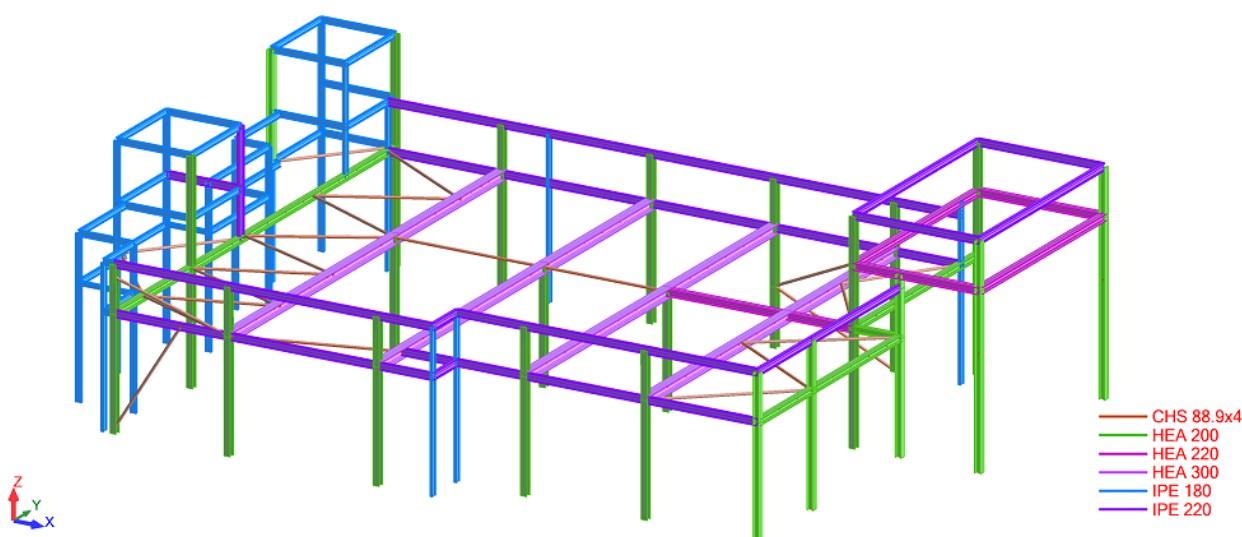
Estrutura e secções utilizadas em Bragança (Local A) (Fonte: Robot Structural analysis)
